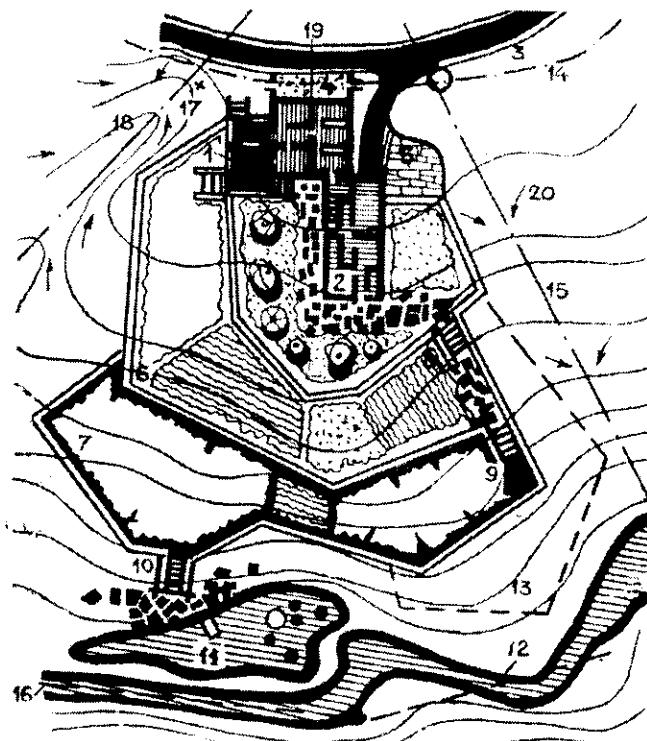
Схема плана сельской жилой усадьбы на склоне
